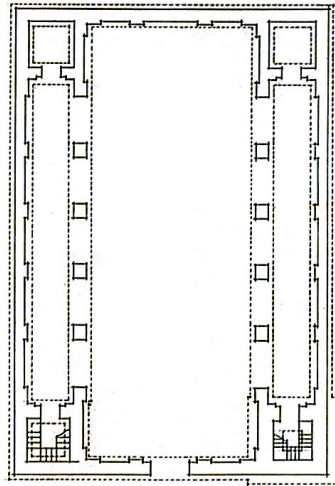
Planta de estructura (muros, pilastras y cimentación) de la capilla, E: 1/100, S/F.
